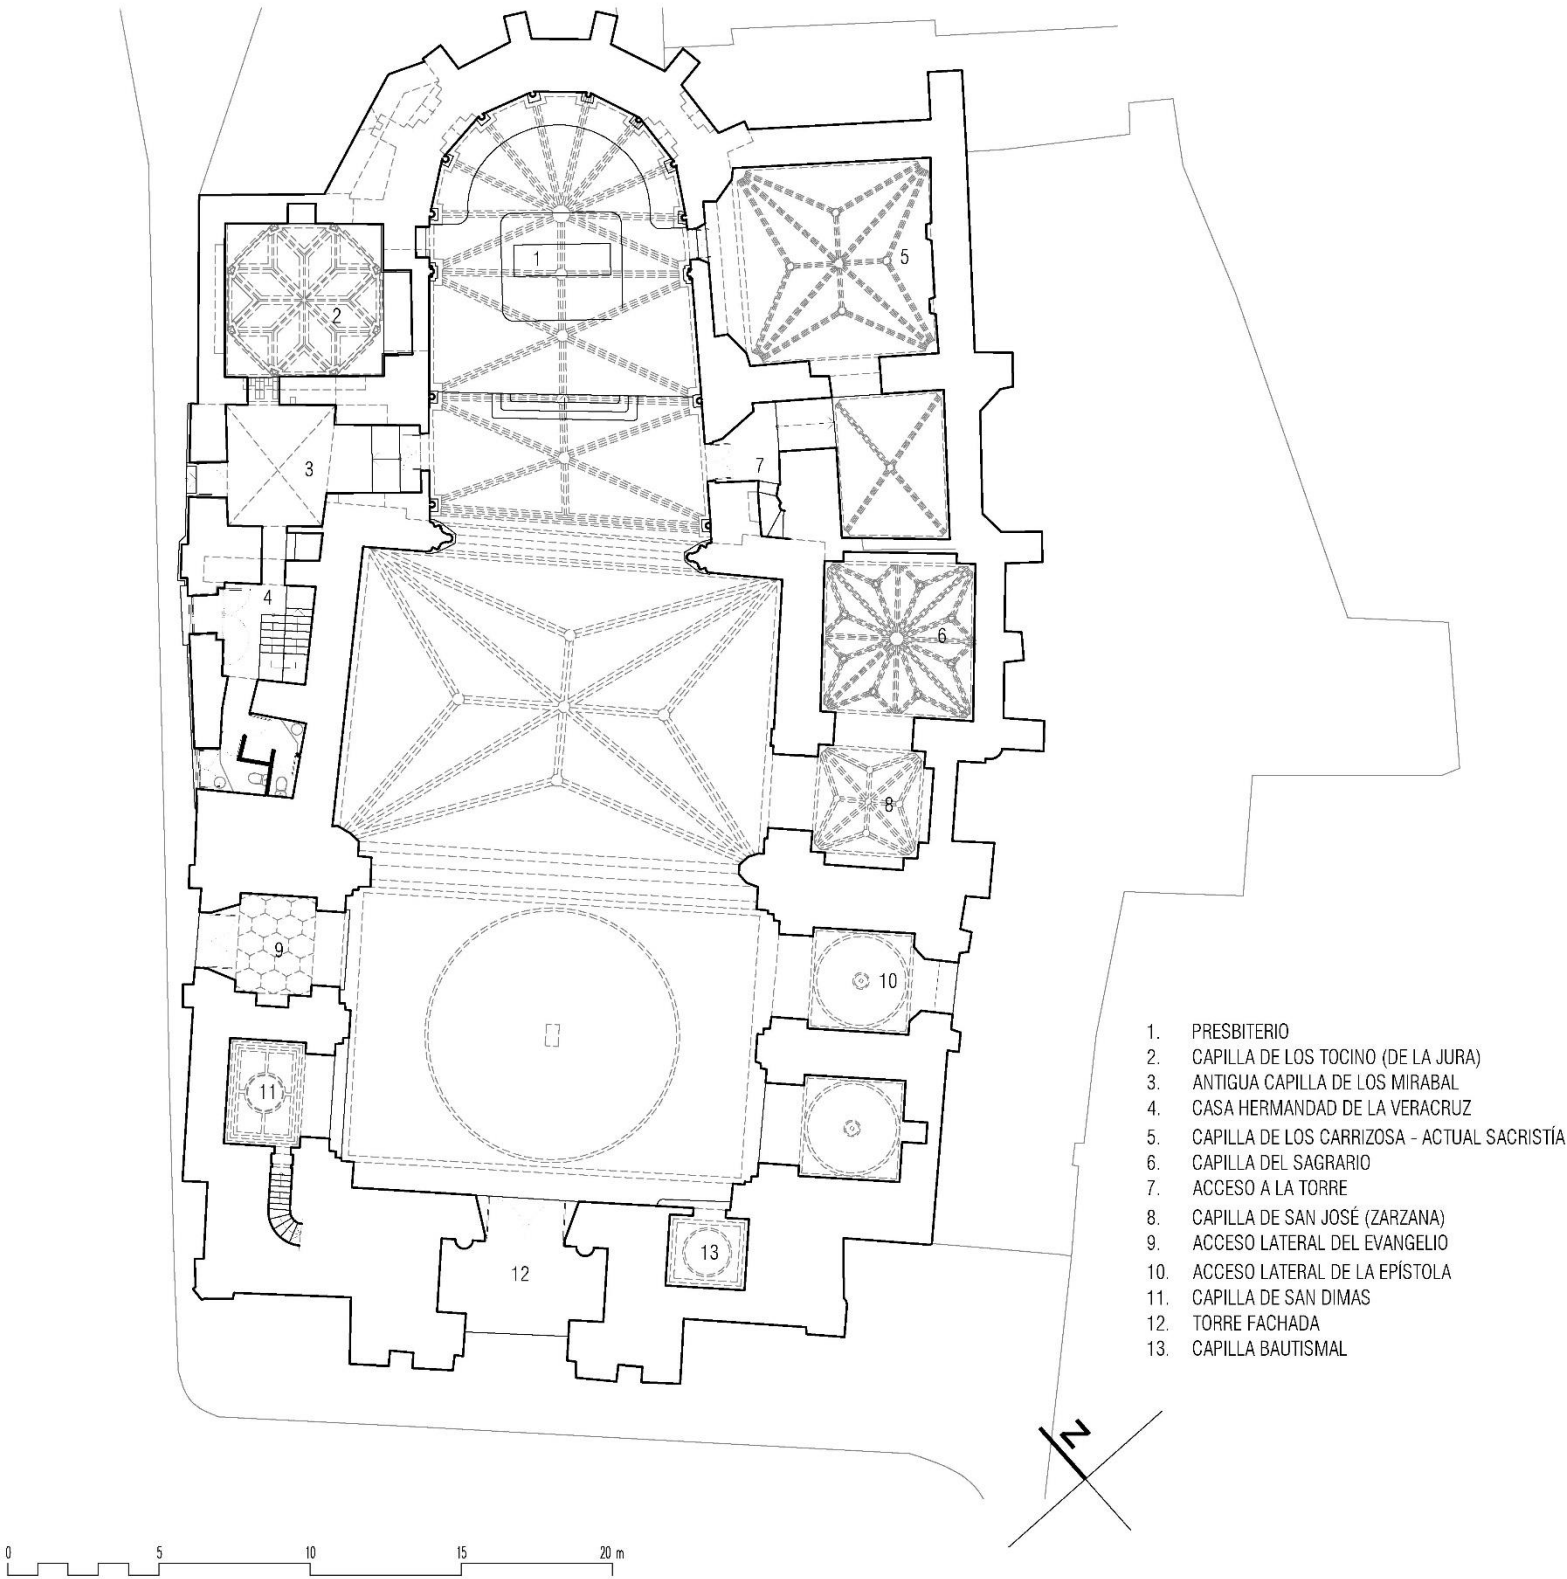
Planta general. Iglesia parroquial de San Juan de los Caballeros. Jerez.
